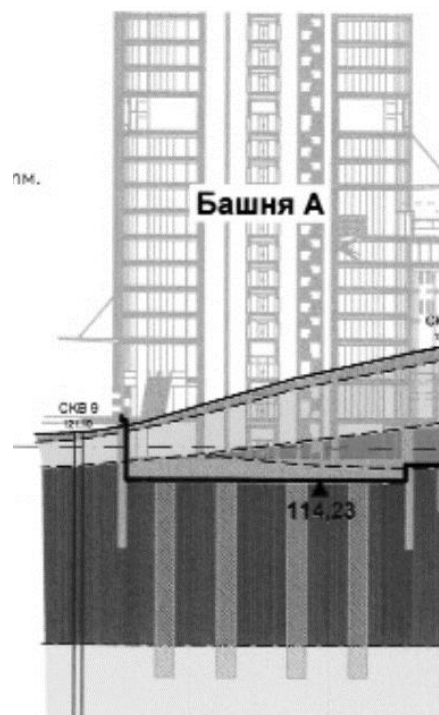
Будівля Mirax Plaza в Києві зведена на комбінованому баретно-плитному фундаменті [7].
